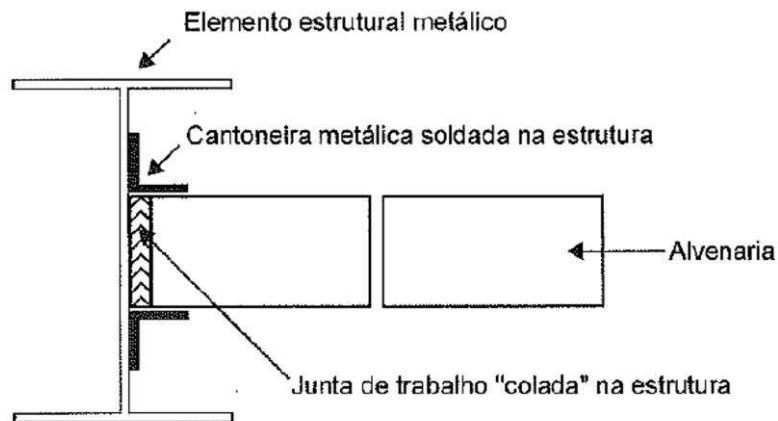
Detalhe da interface da alvenaria com o pilar de aço, onde é executada uma junta de trabalho (SALGADO, 2009).
